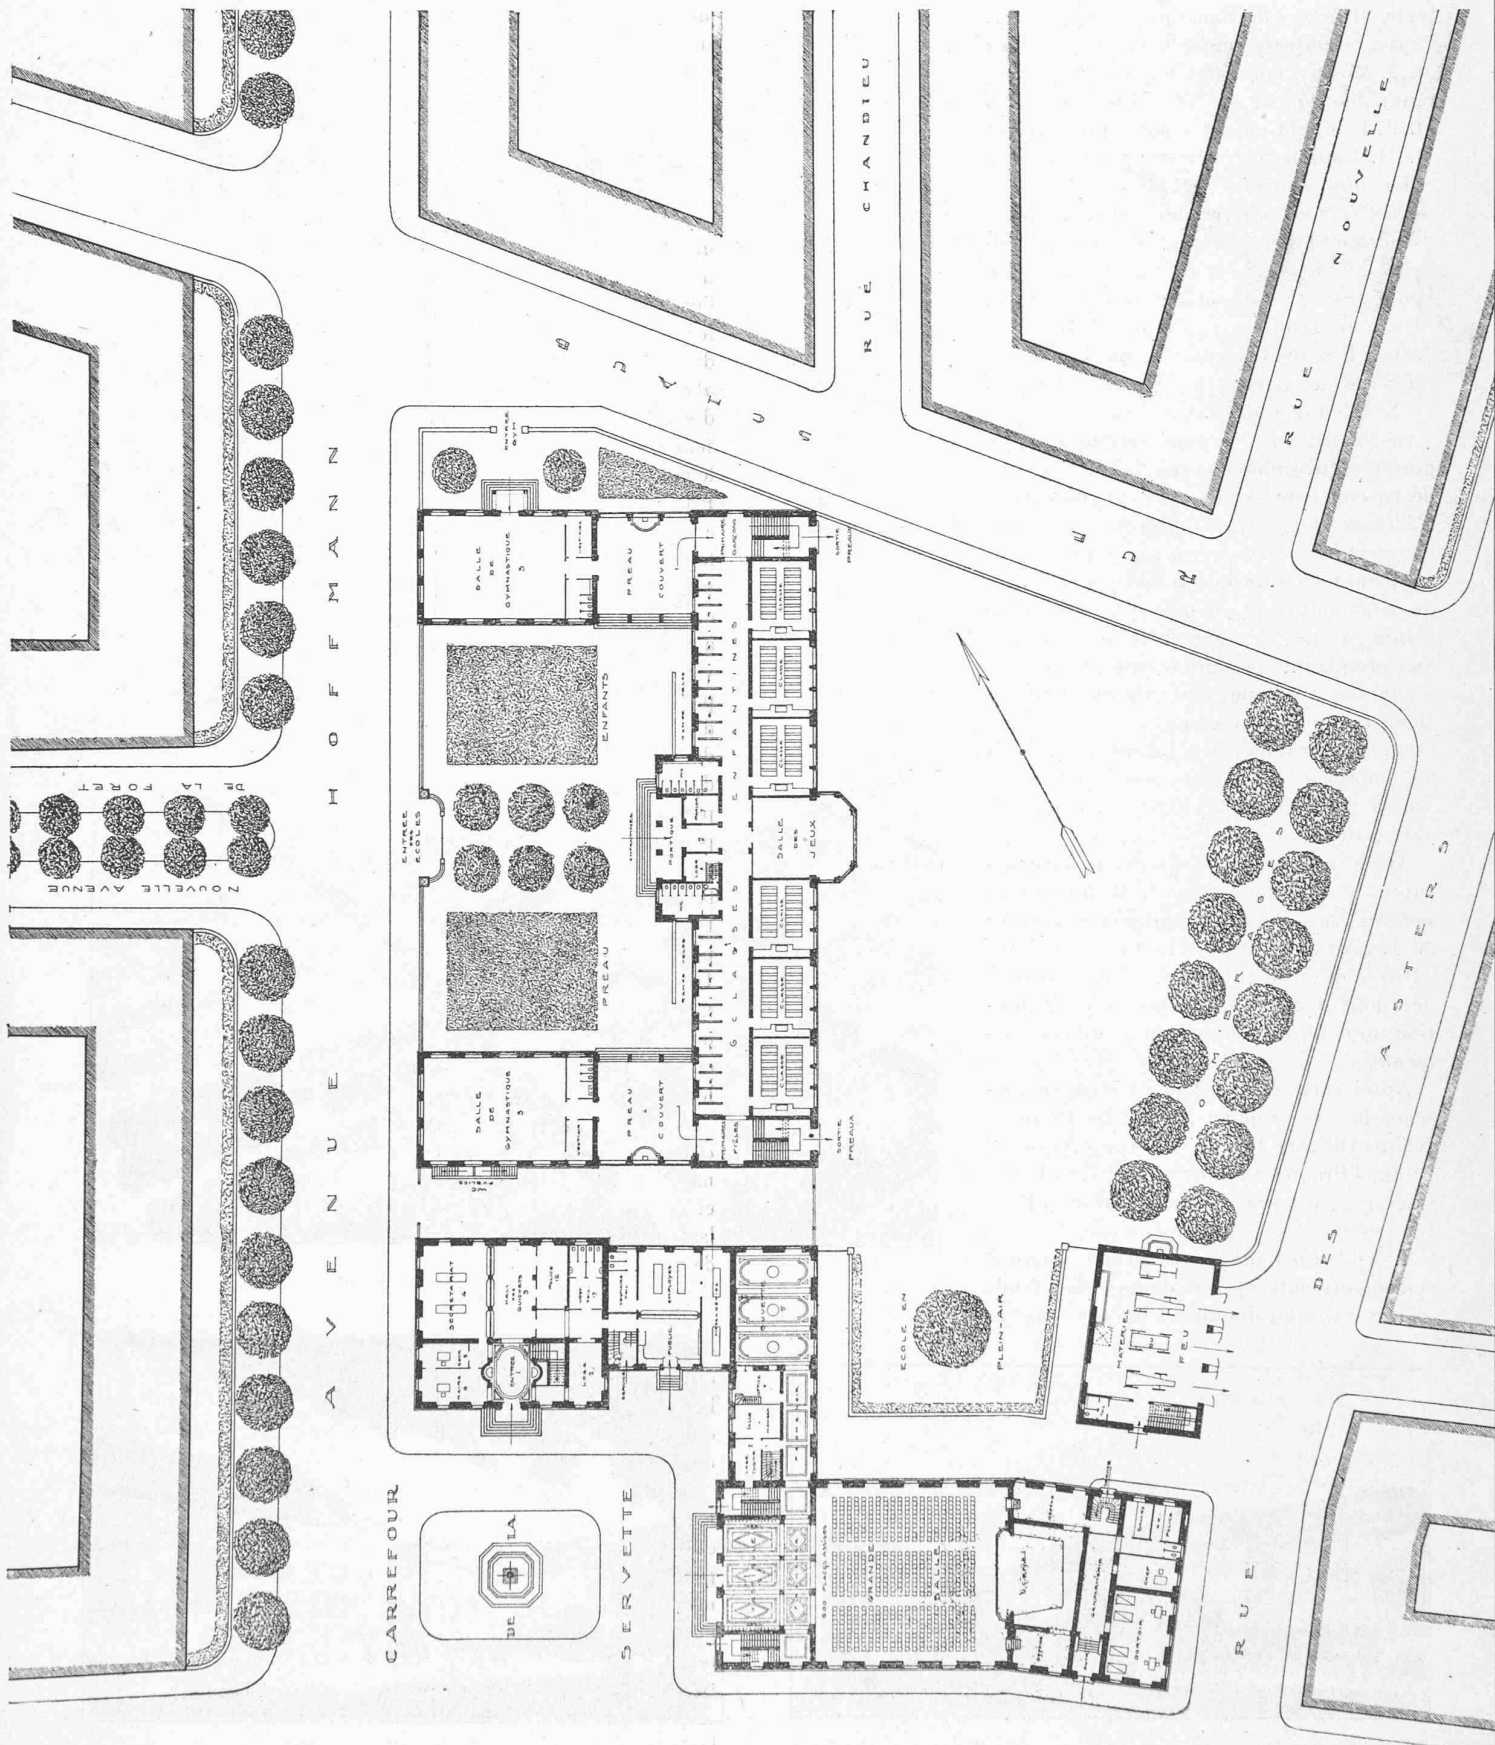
Plan général et rez-de-chaussée. — 1 : 800.
